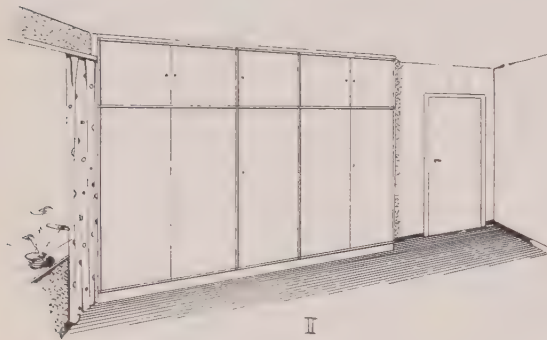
Einbauschränk, auch umzugsfähig, in holzsparender Bauweise, Inneneinrichtung aus gepreßtem Kunststoff
